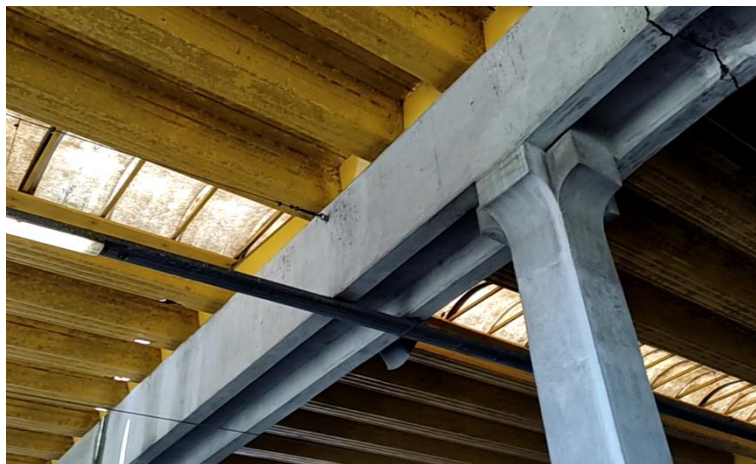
Cobertura das Plataformas com ferrugem e danificadas, trinca e infiltração na viga
